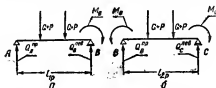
Расчетные схемы для определения поперечных сил в главной балке.
